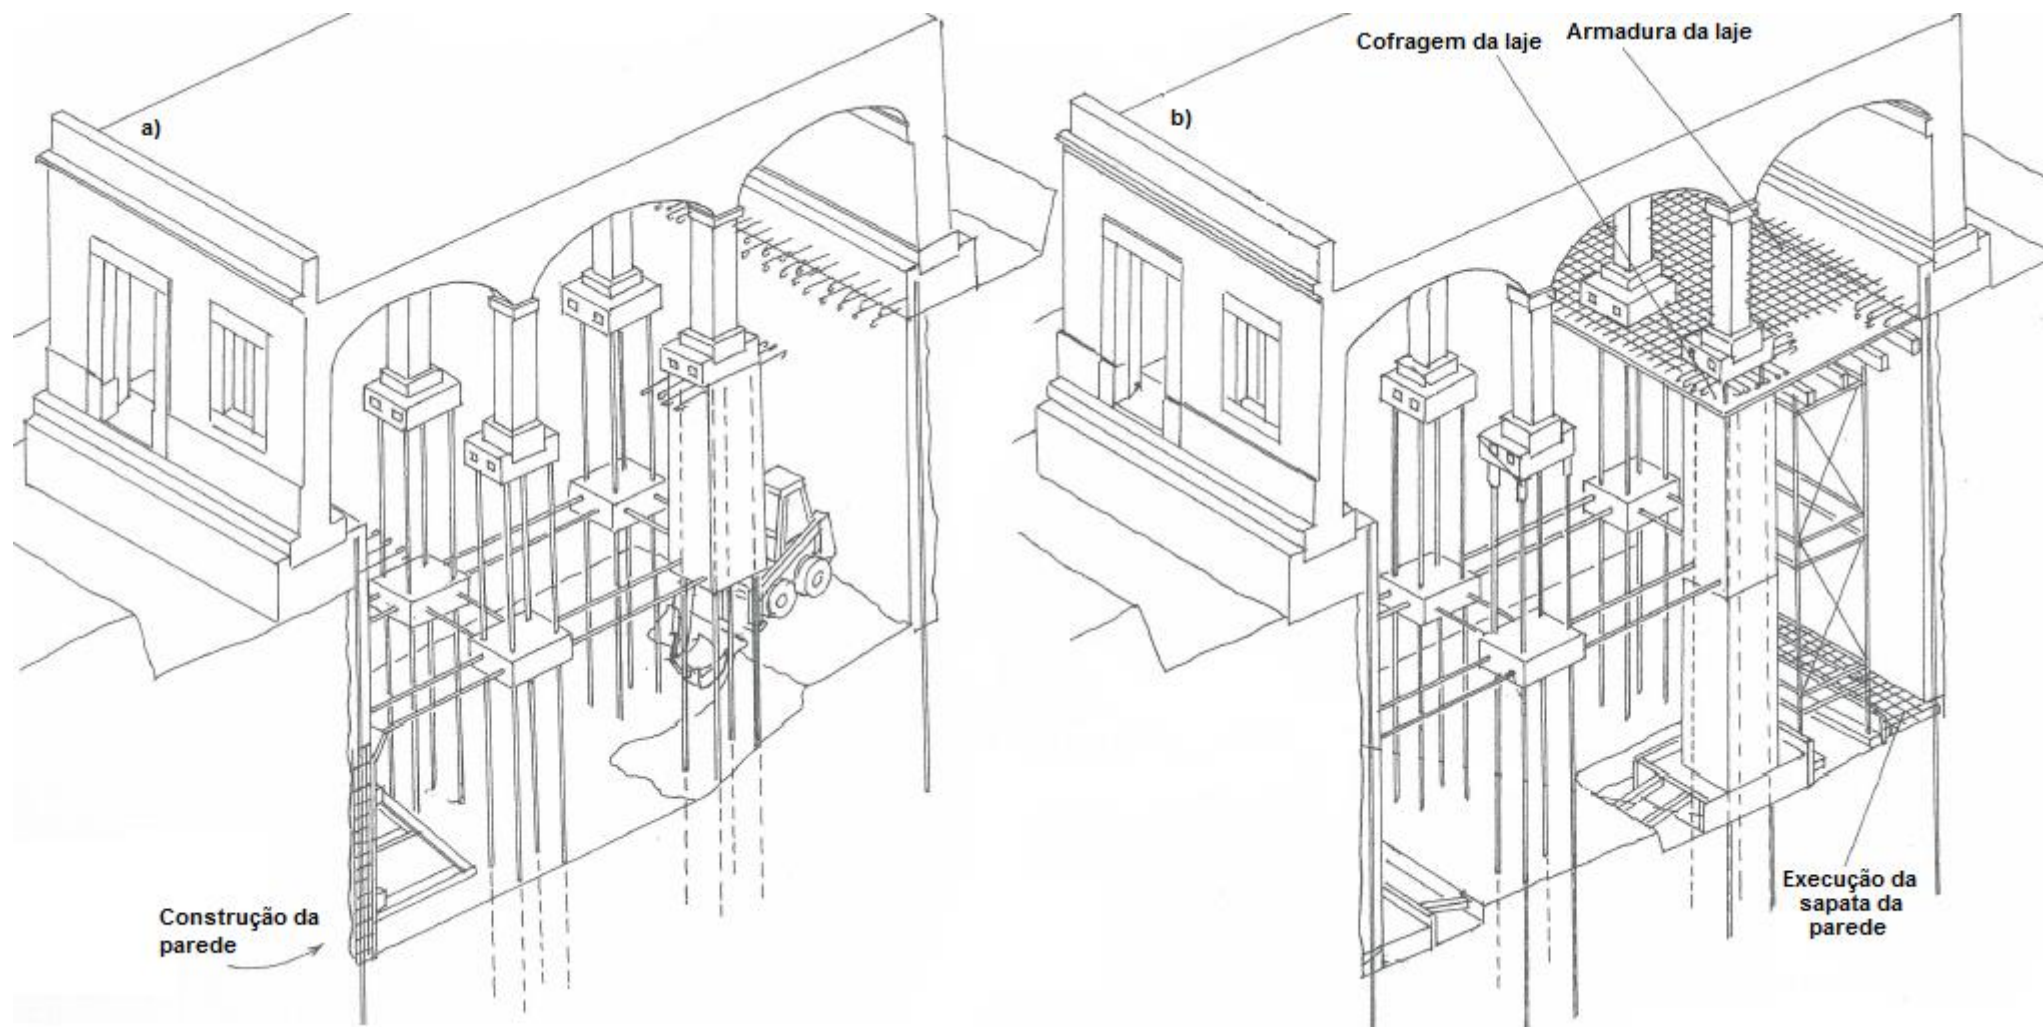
Construção da cave: a) escavação e construção dos painéis do segundo nível de escavação; b) construção da laje superior [55]
